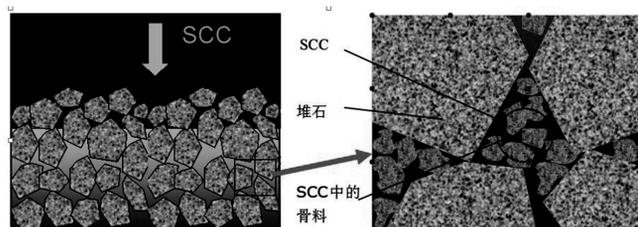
专用自密实混凝土充填堆石体形成堆石混凝土示意图
